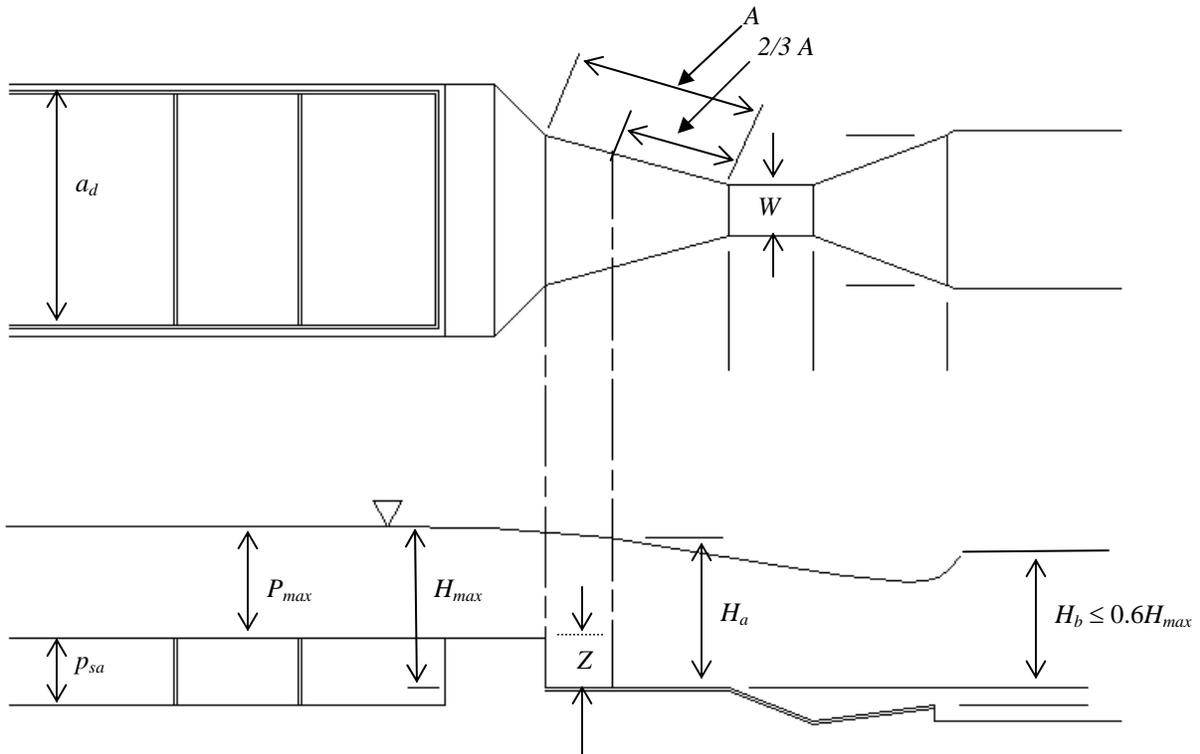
Una Canaleta Parshall al Extremo de Un Desarenador Rectangular
